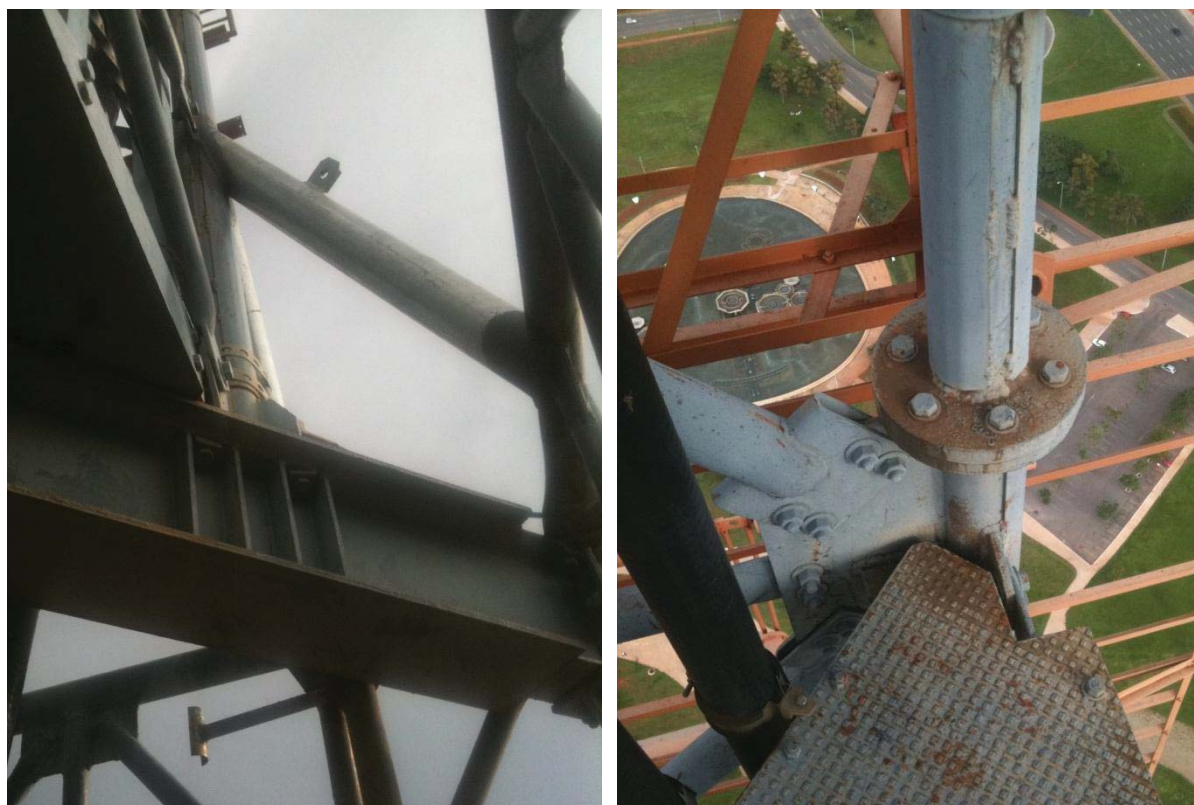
Detalhe da Transição do Trecho III (Fonte: Autor)
